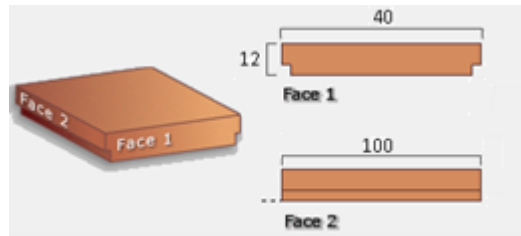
Dimensões do enchimento de EPS para lajes treliçadas
